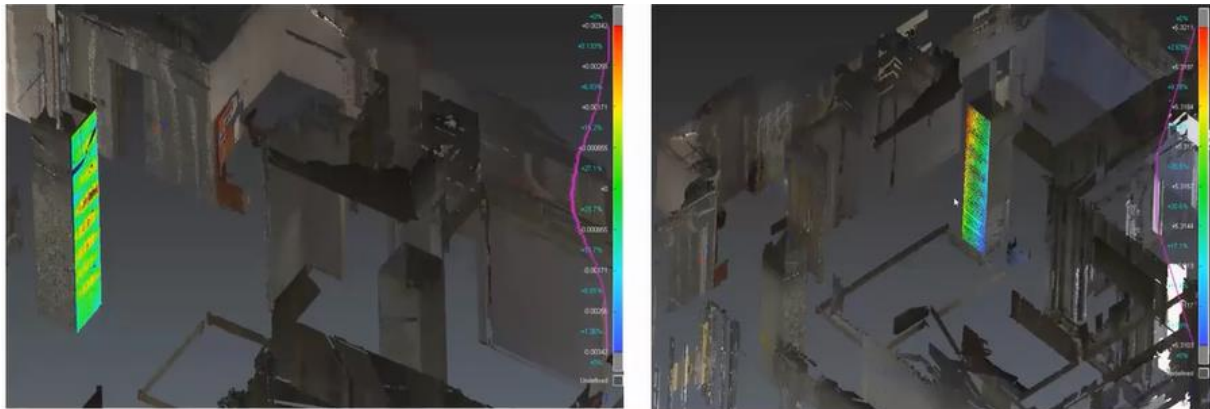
Vérification de la planéité du béton d'un poteau en BIM.
